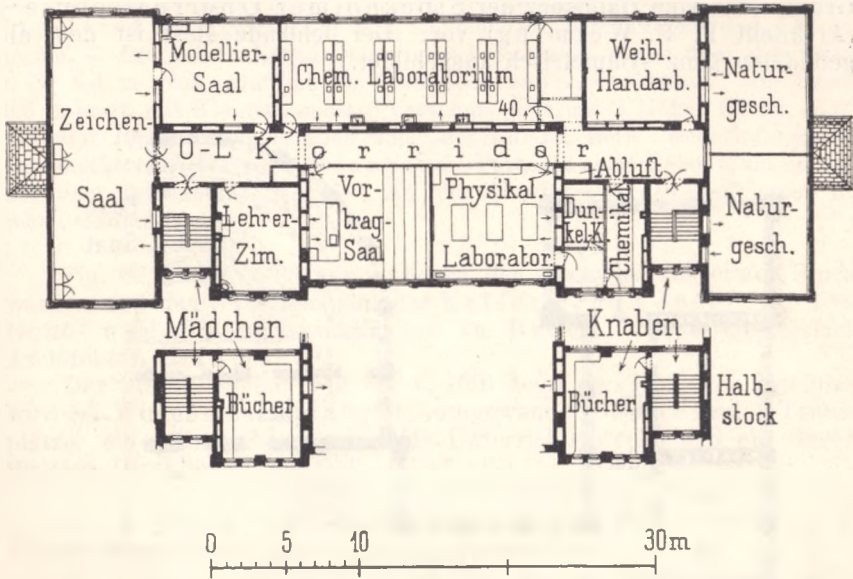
Grundriß des Dachgeschosses der higher grade school, Cassland road, London, nach Bailey.
